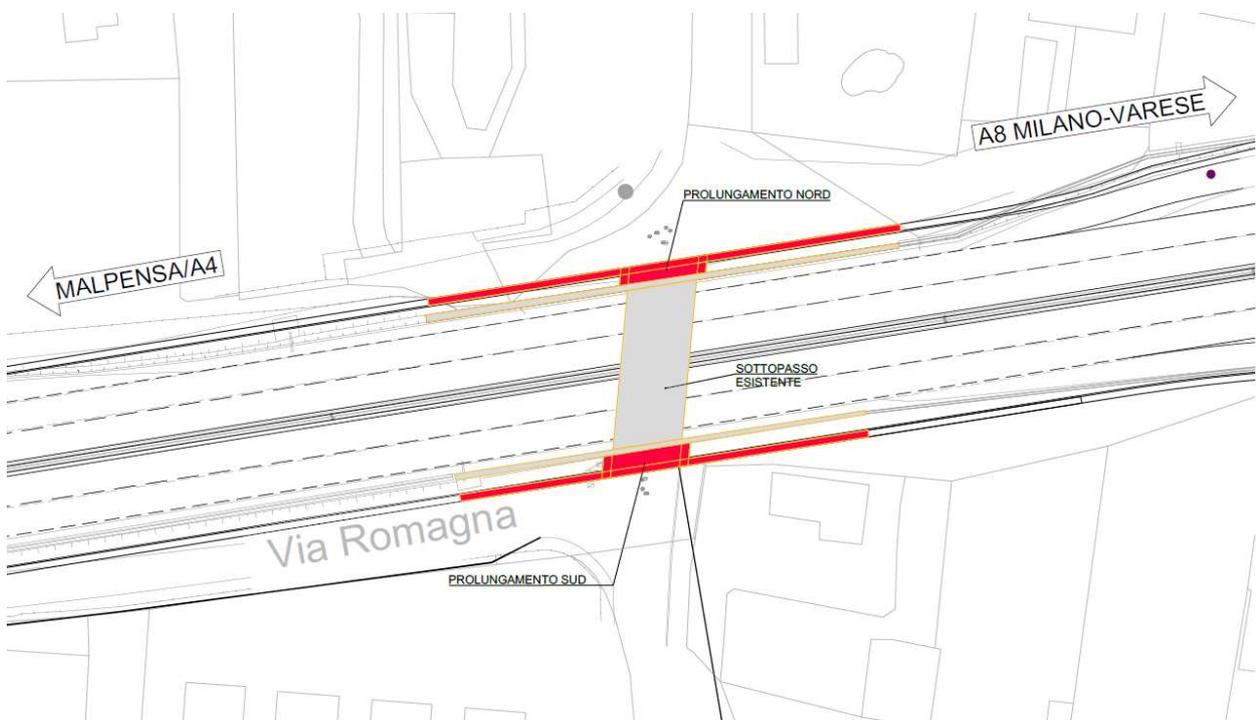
stralcio planimetrico sottopasso via Correnti
